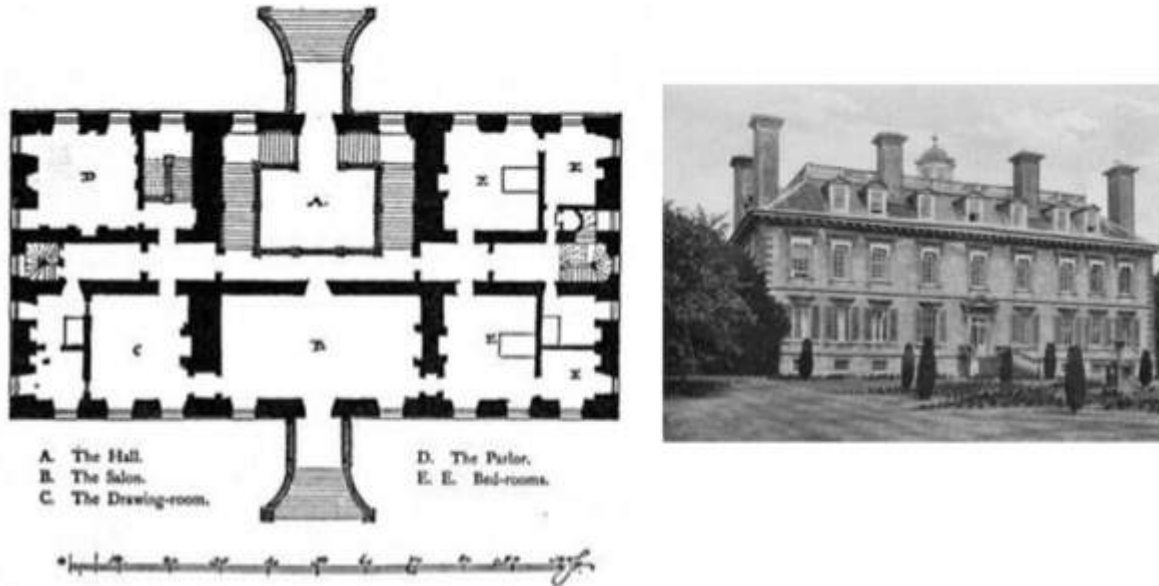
Planta y fotografía de Coleshill, proyectada por Sir Roger Pratt.
